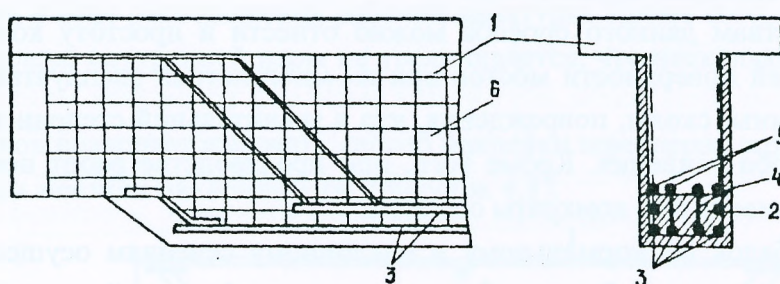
Усиление балок при помощи железобетонной рубашки: 1 – балка; 2 – дополнительный слой бетона; 3 – дополнительная продольная арматура; 4 – коротыши; 5 – основная рабочая арматура; 6 – противоусадочная арматура.
